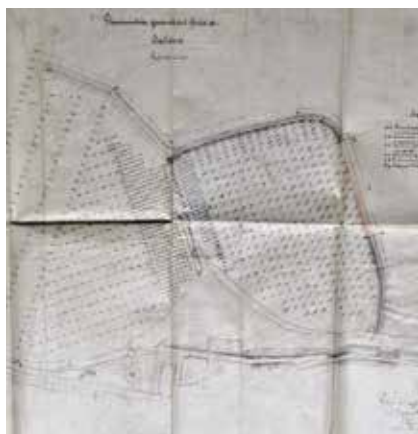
G. Lenzi, *Planimetria generale del porto di Salerno*, 30-8-1886 (ASSa, Genio Civile, b. 349).
